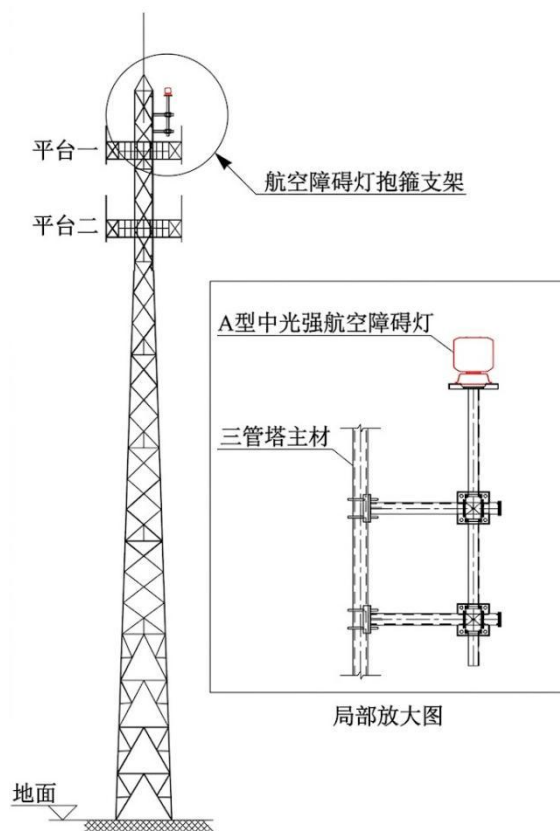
三管塔设置航空障碍灯支架立面图
